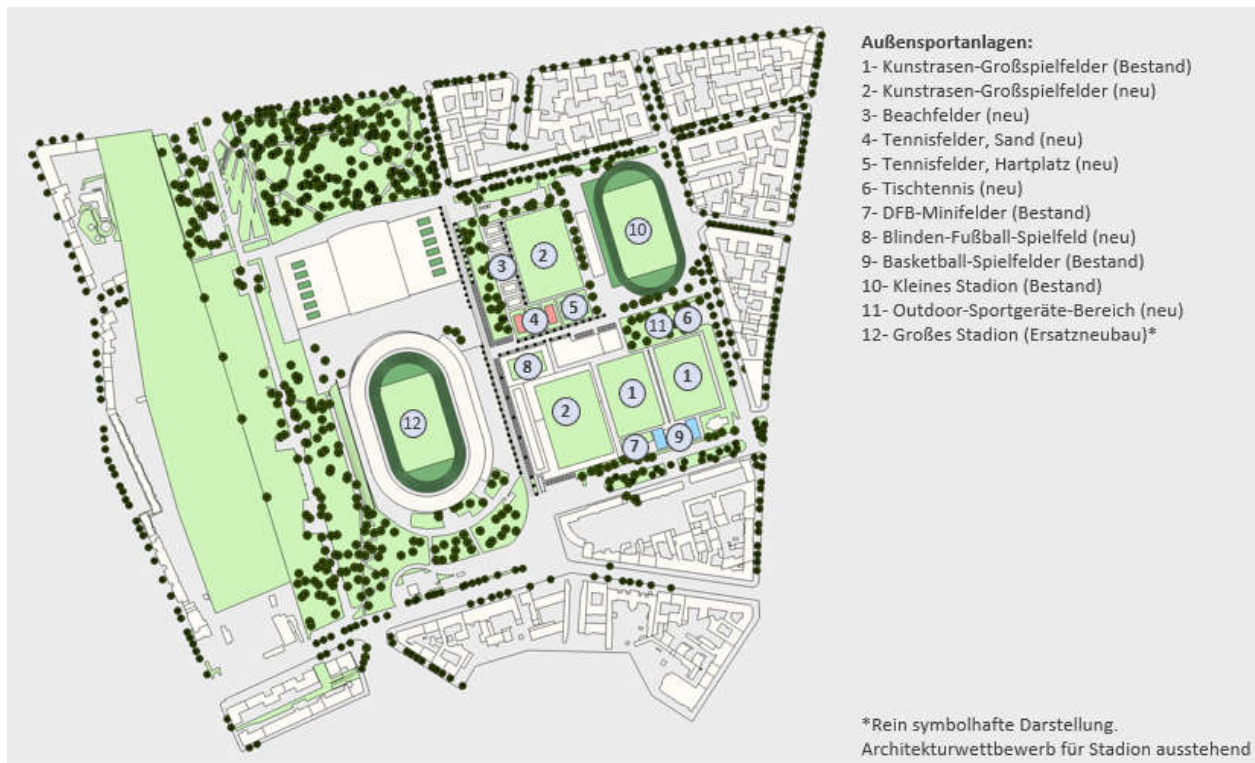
Lageplankonzeption Variante 2 – Außensportanlagen
